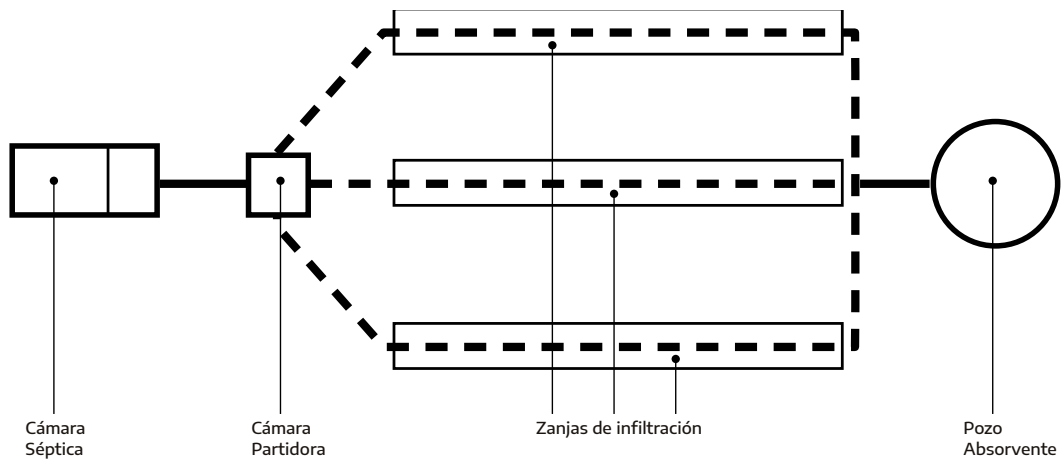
Sistemas de infiltración mixtos. Zanjas de infiltración, más pozo absorbente. Planta.
